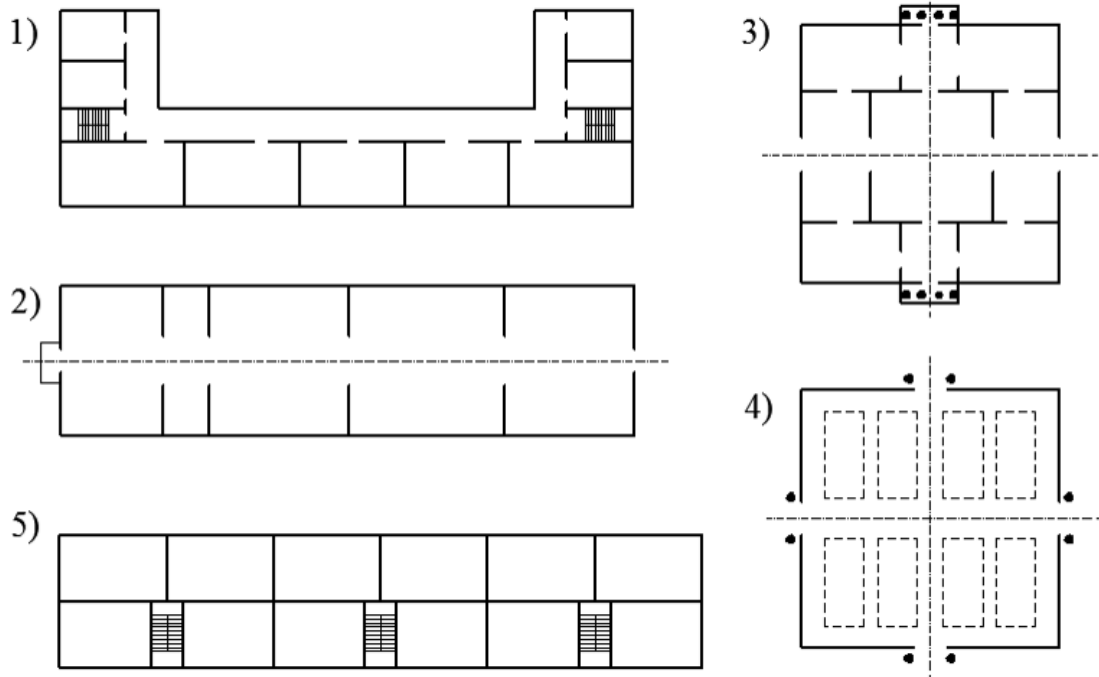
Планувальні композиційні схеми будівель:
